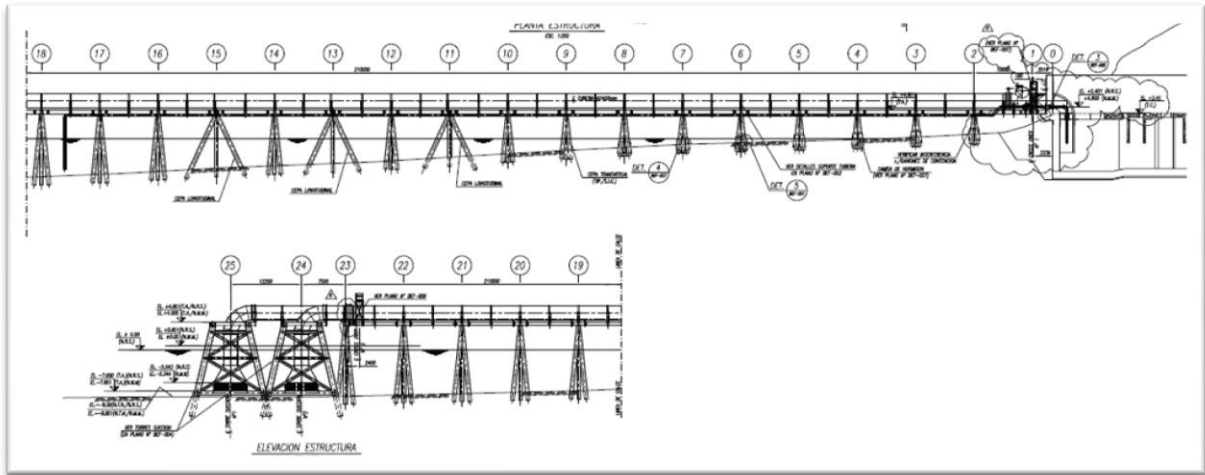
Vista en perfil de la estructura del sifón de captación de agua de mar
